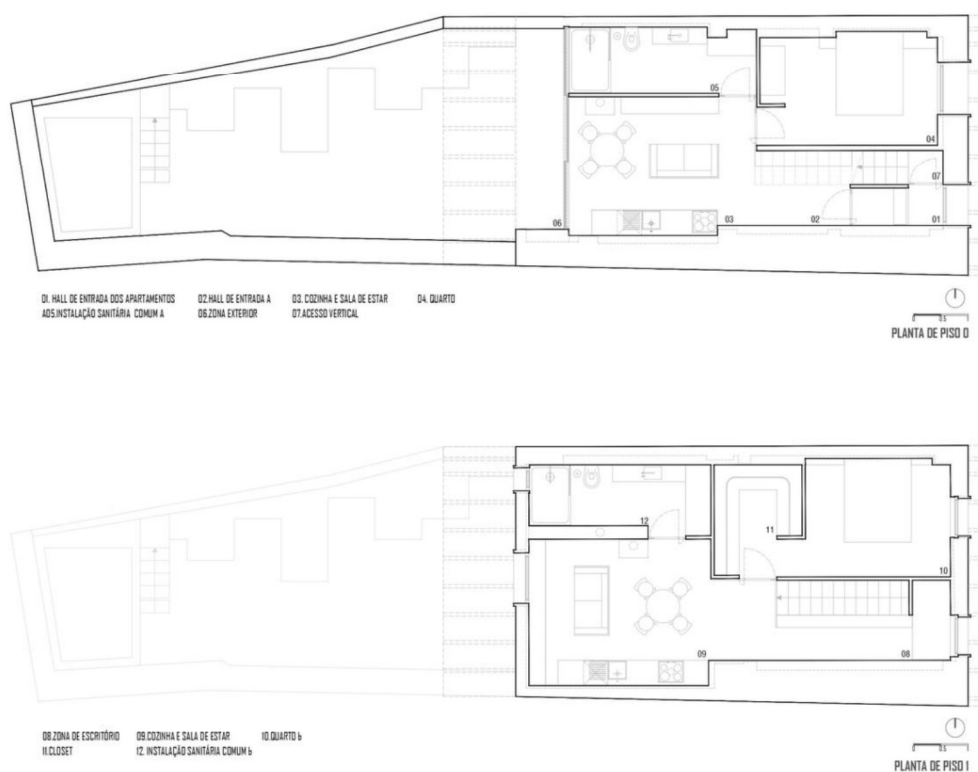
Planta de Piso 0 e Piso 1. Fonte: Bruno Dias Arquitetura.
